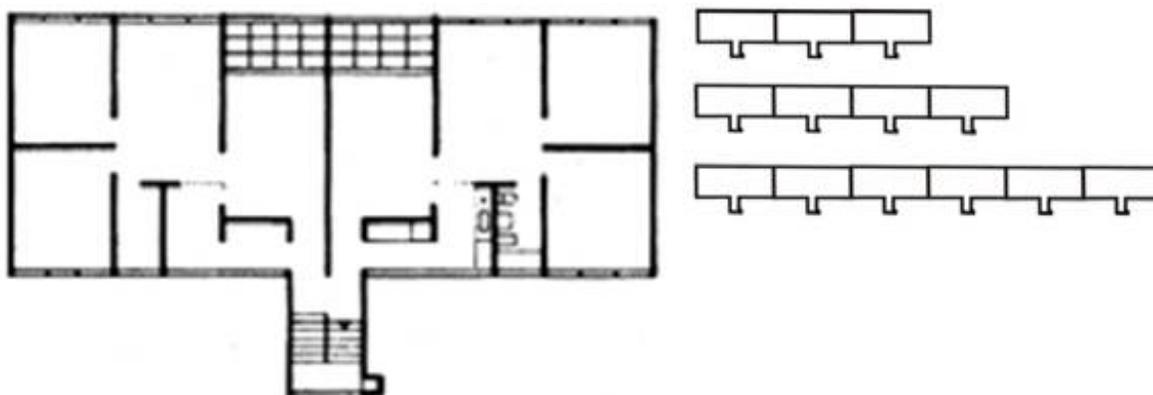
Planta baixa da tipologia habitacional existente no bloco de quatro pavimentos da Vila Guiomar.
